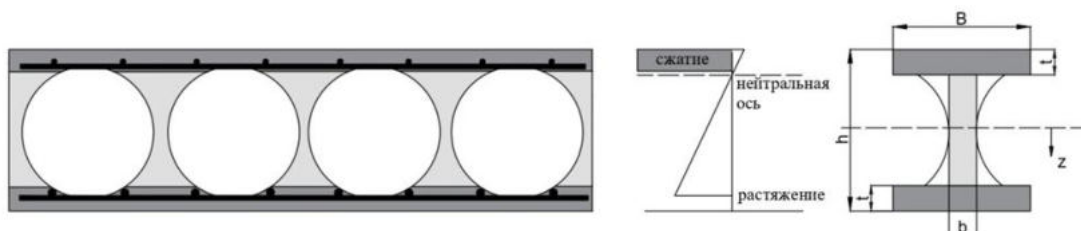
Распределение напряжений в железобетонном сечении при изгибающем моменте. Расчётное поперечное сечение
